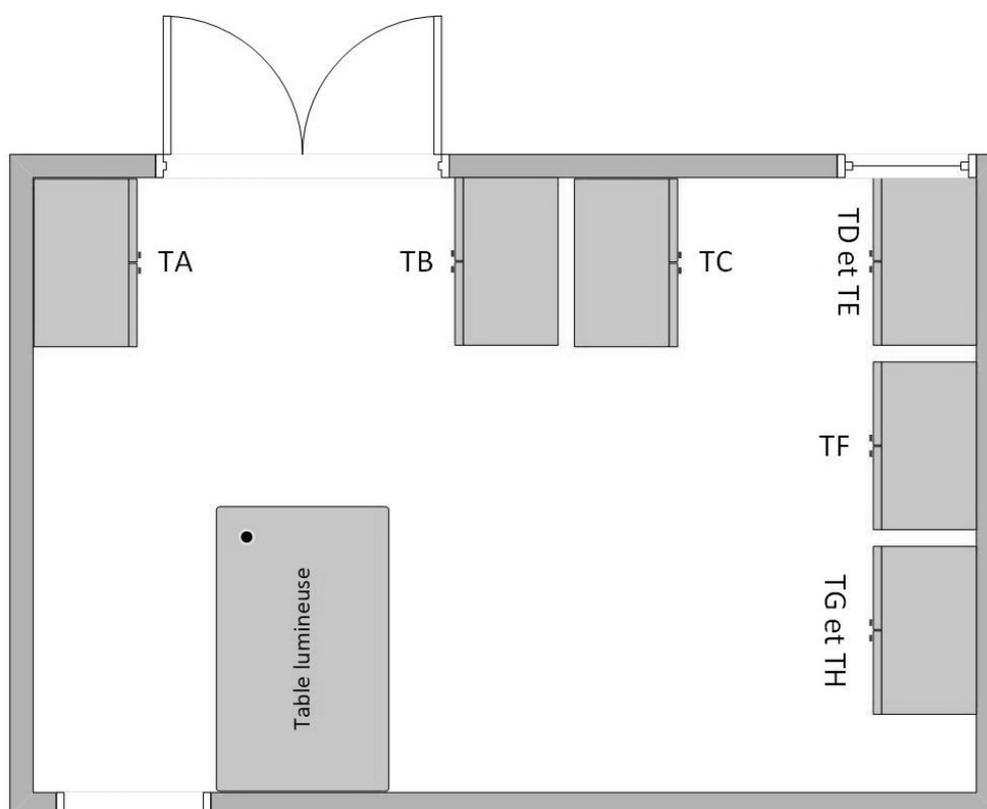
Plan de la salle C107 (plan établi par Hervé Genton)
